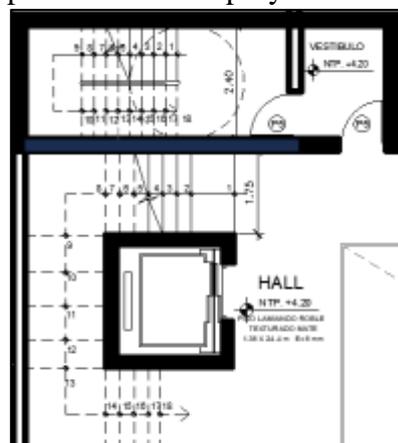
Planta segundo nivel del proyecto-biblioteca- escalera de evacuación.
